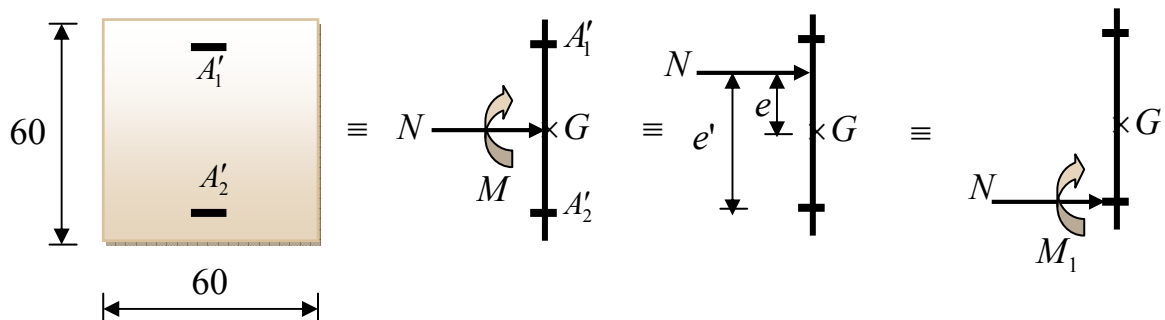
Position de N_1 et M_1 sur la section transversale.
